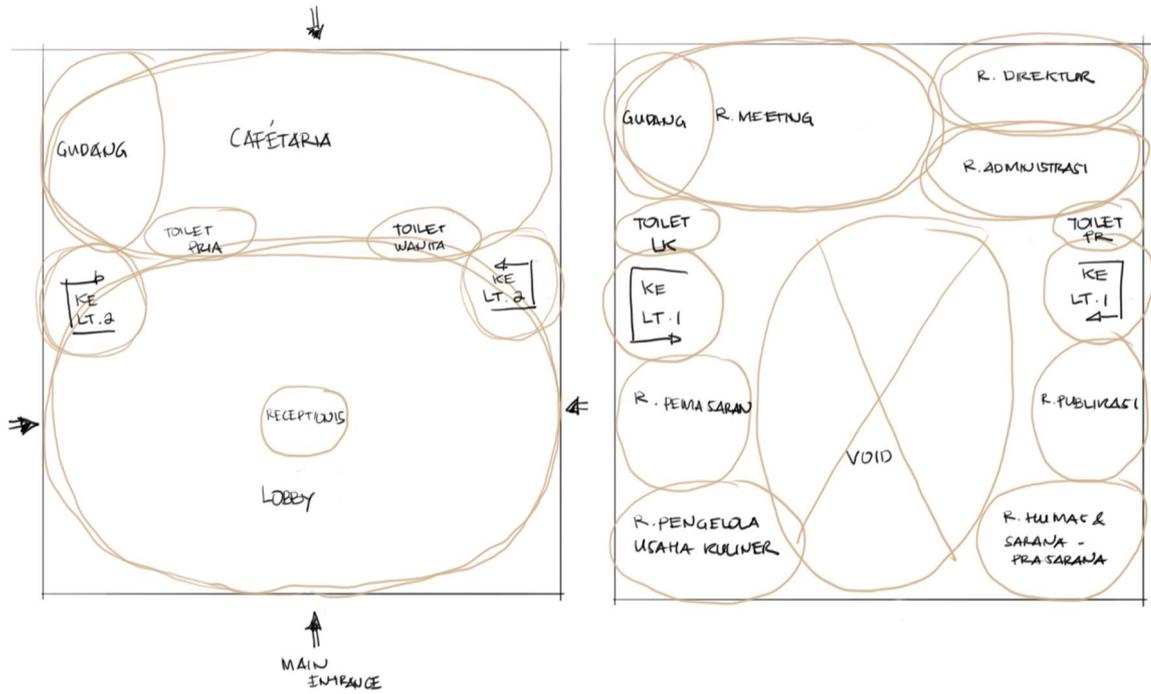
Bubble plan café lantai 1 dan lantai 2
